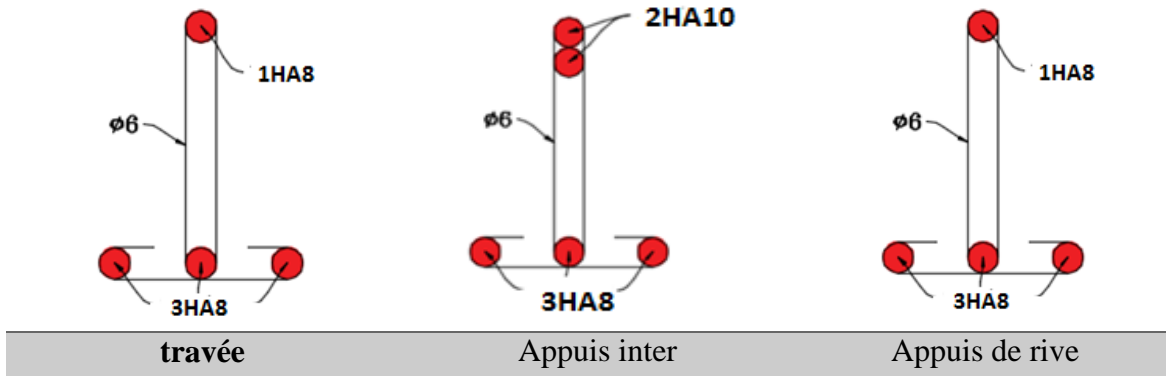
Schémas de ferrailage des poutrelles étage courant
